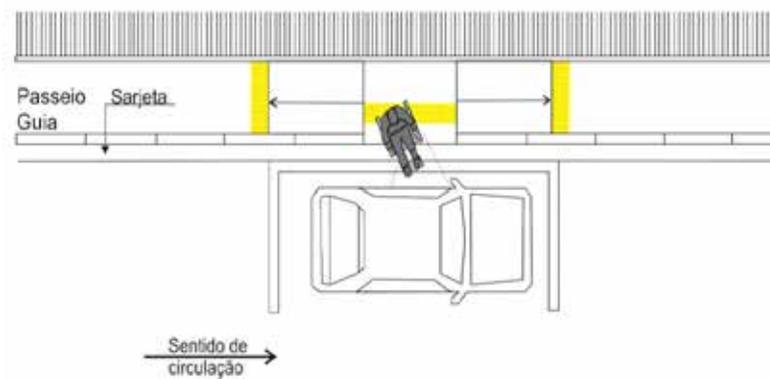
Vaga junto ao passeio rebaixado – Vista superior
